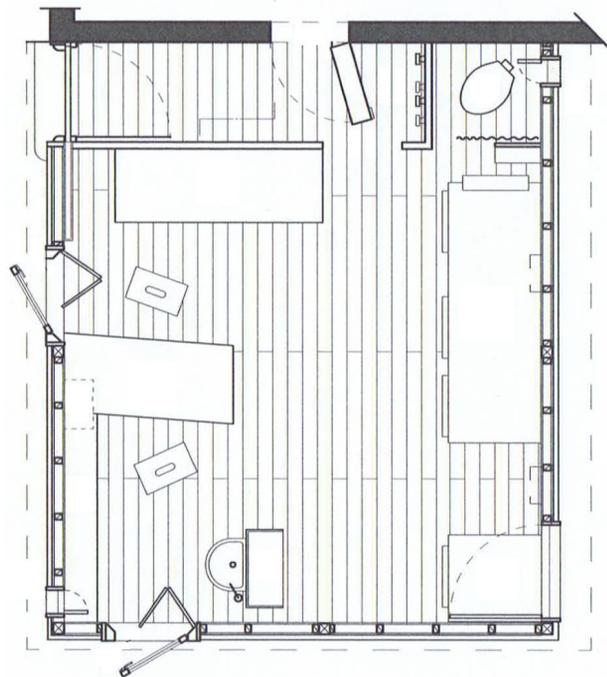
Grundriss des Ferienhauses, welches in Holzrahmenbauweise konstruiert wurde und als vorgefertigtes Gebäude zum Bauplatz transportiert wurde. Für das Le Cabanon verwendete Le Corbusier ein offenes Grundrisskonzept, einzelne Bereiche wurden mit unterschiedlich gefärbten Farbtafeln definiert.
